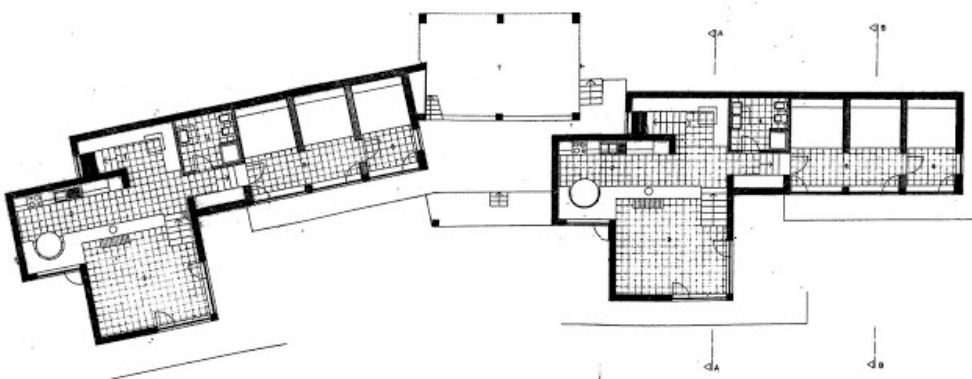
Planta Conjunto de Sérgio Fernandez
